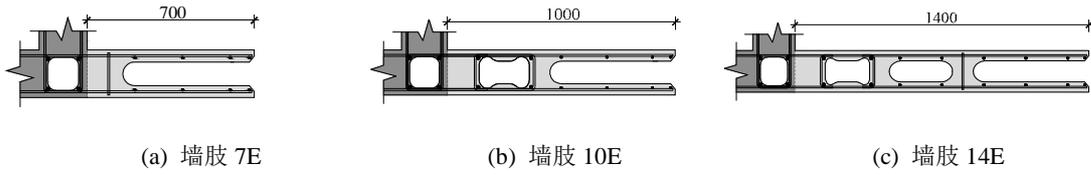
L形、T形预制构造边缘构件空心墙板与空心墙板或现浇墙连接的
